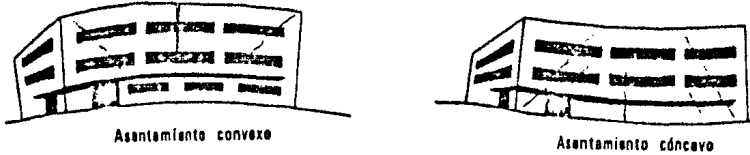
Modelos de las grietas por asentamientos.
